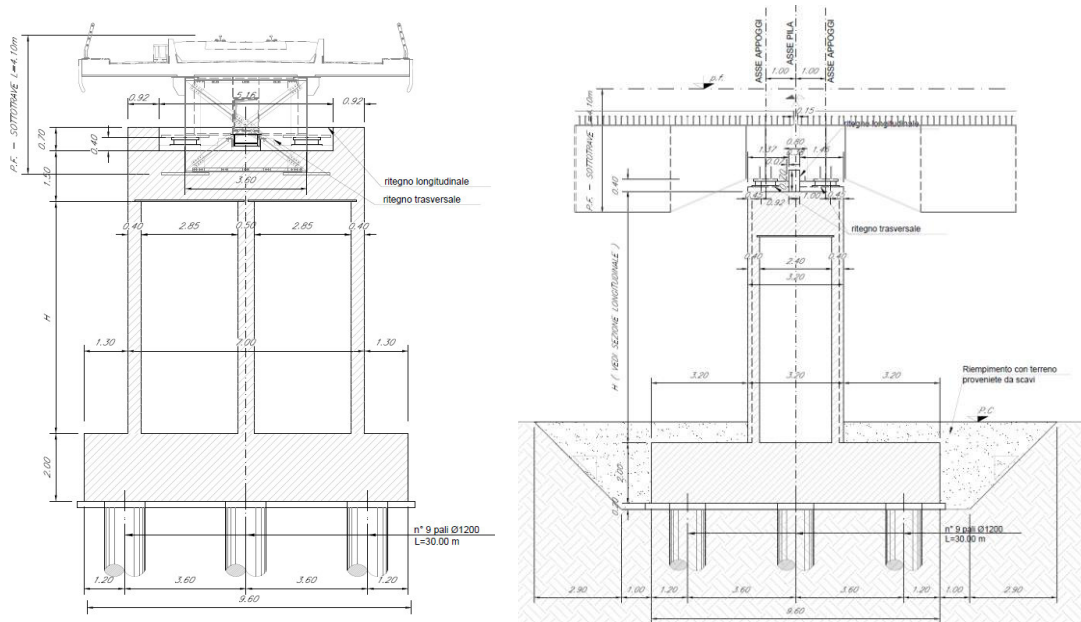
Vista in pianta pila- a) ; sezione di dettaglio fusto pila b) sezione di spiccato
